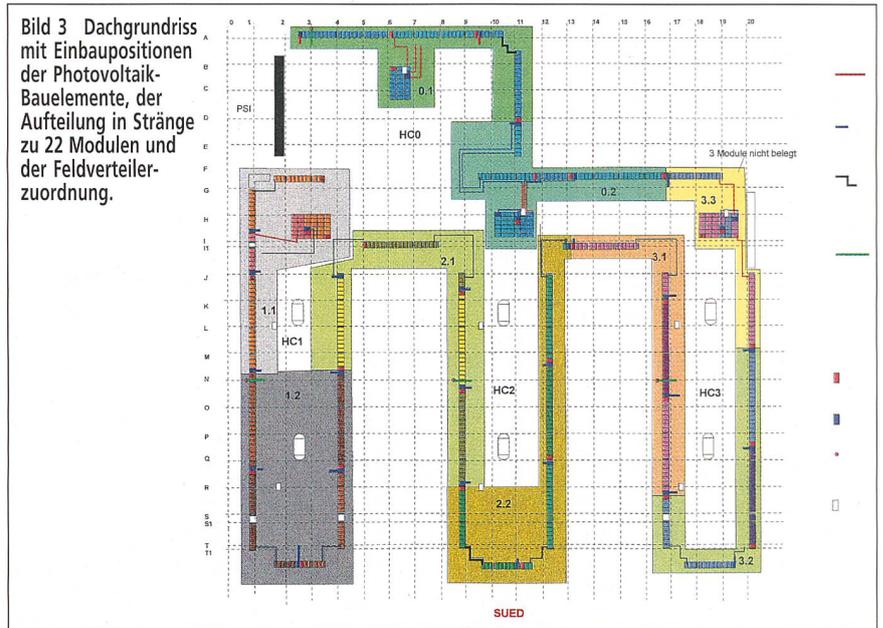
Dachgrundriss mit Einbaupositionen der Photovoltaik-Bauelemente, der Aufteilung in Stränge zu 22 Modulen und der Feldverteilungsanordnung.
